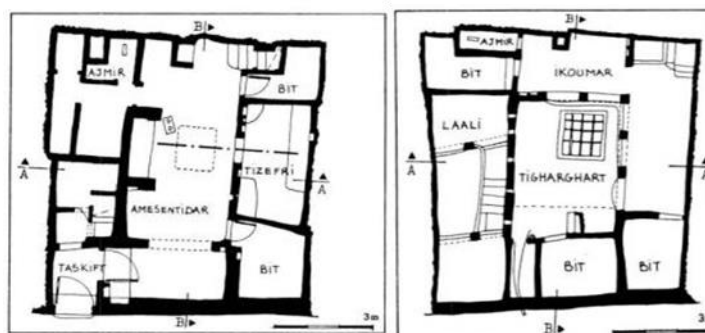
3: Plan RDC et R+1 source: une leçon d'architecture, Andrée Ramereau.
